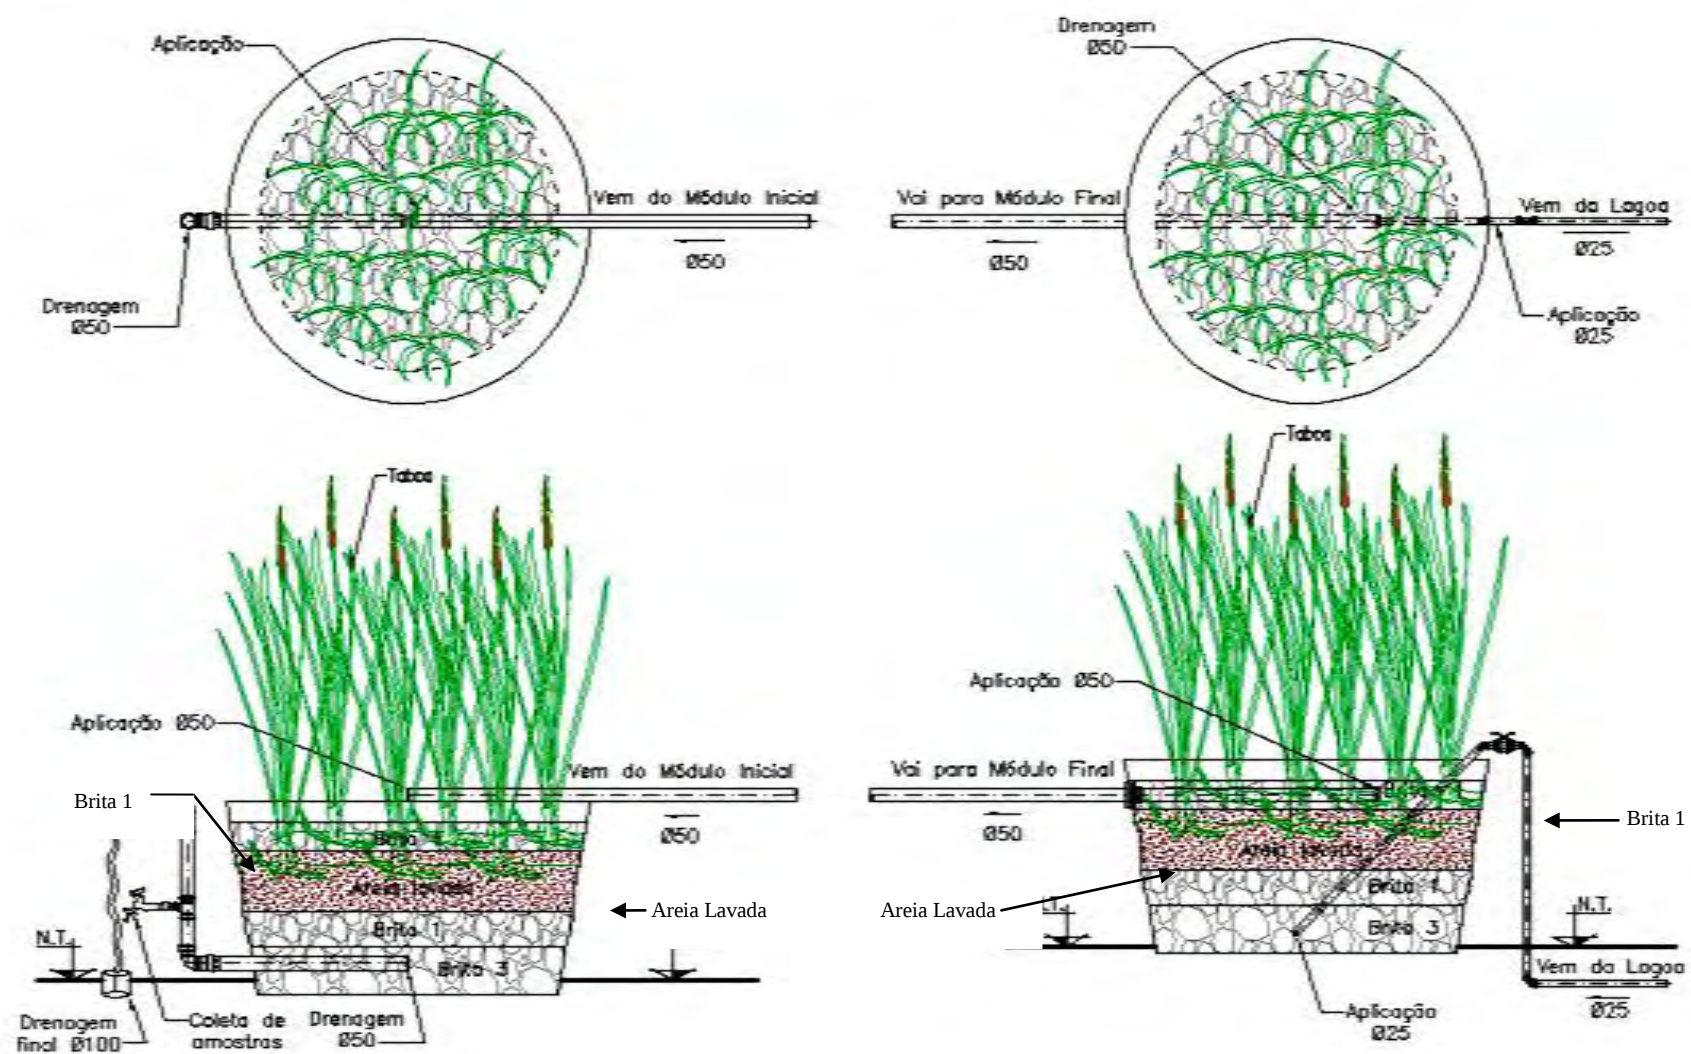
Vistas em planta baixa e em corte dos módulos de tratamento.
